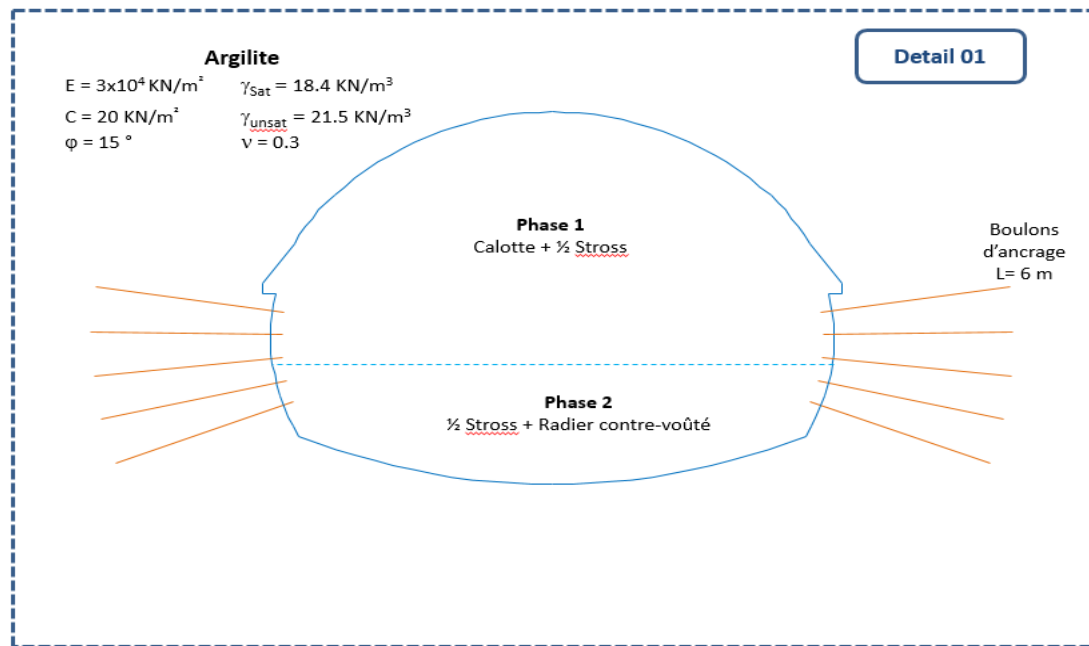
Détail N°01 de la vue en coupe du tunnel.
